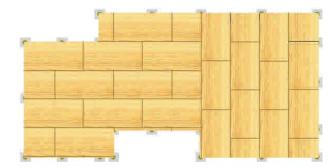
13: El plano de planta de construcción debe especificar la disposición de los tableros estructurales: contrachapado fenólico (terciado estructural) o de hebras orientadas (OSB).
